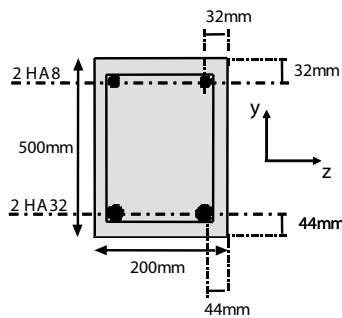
Coupe transversale : distributions des armatures dans la poutre.
